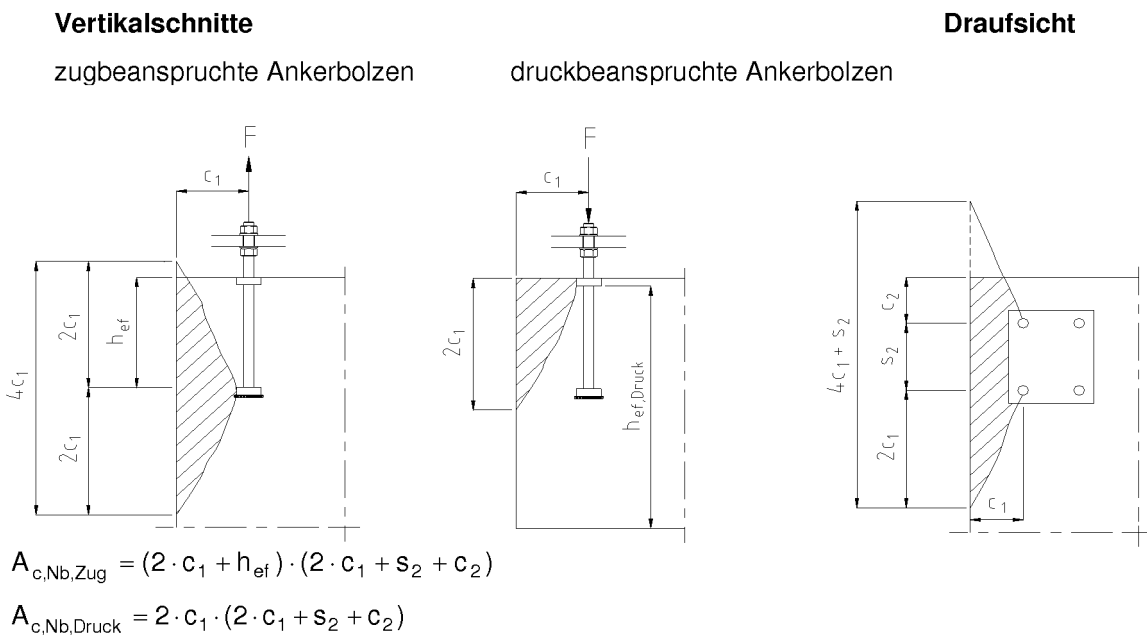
Beispiel für lokalen Betonausbruch am Bauteilrand
